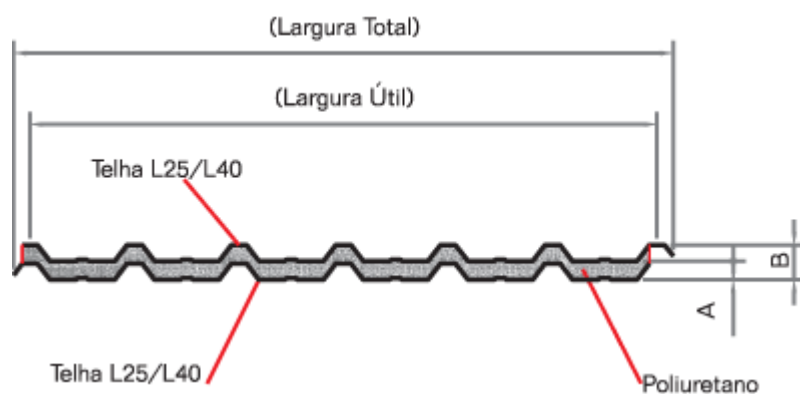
Detalhe da telha com isolamento em poliuretano
